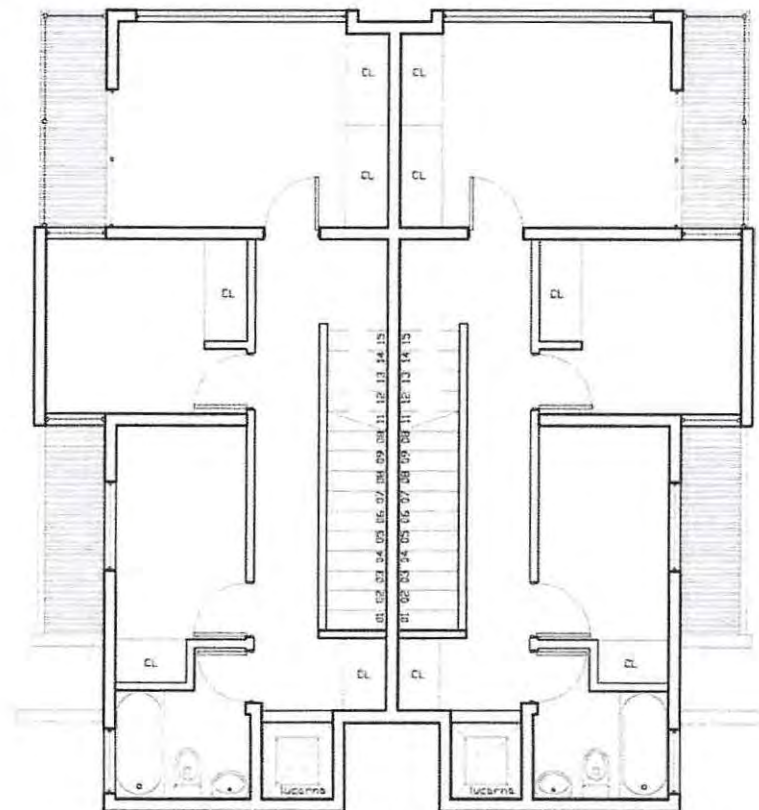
Planta arquitectura segundo piso vivienda pareada [21]
